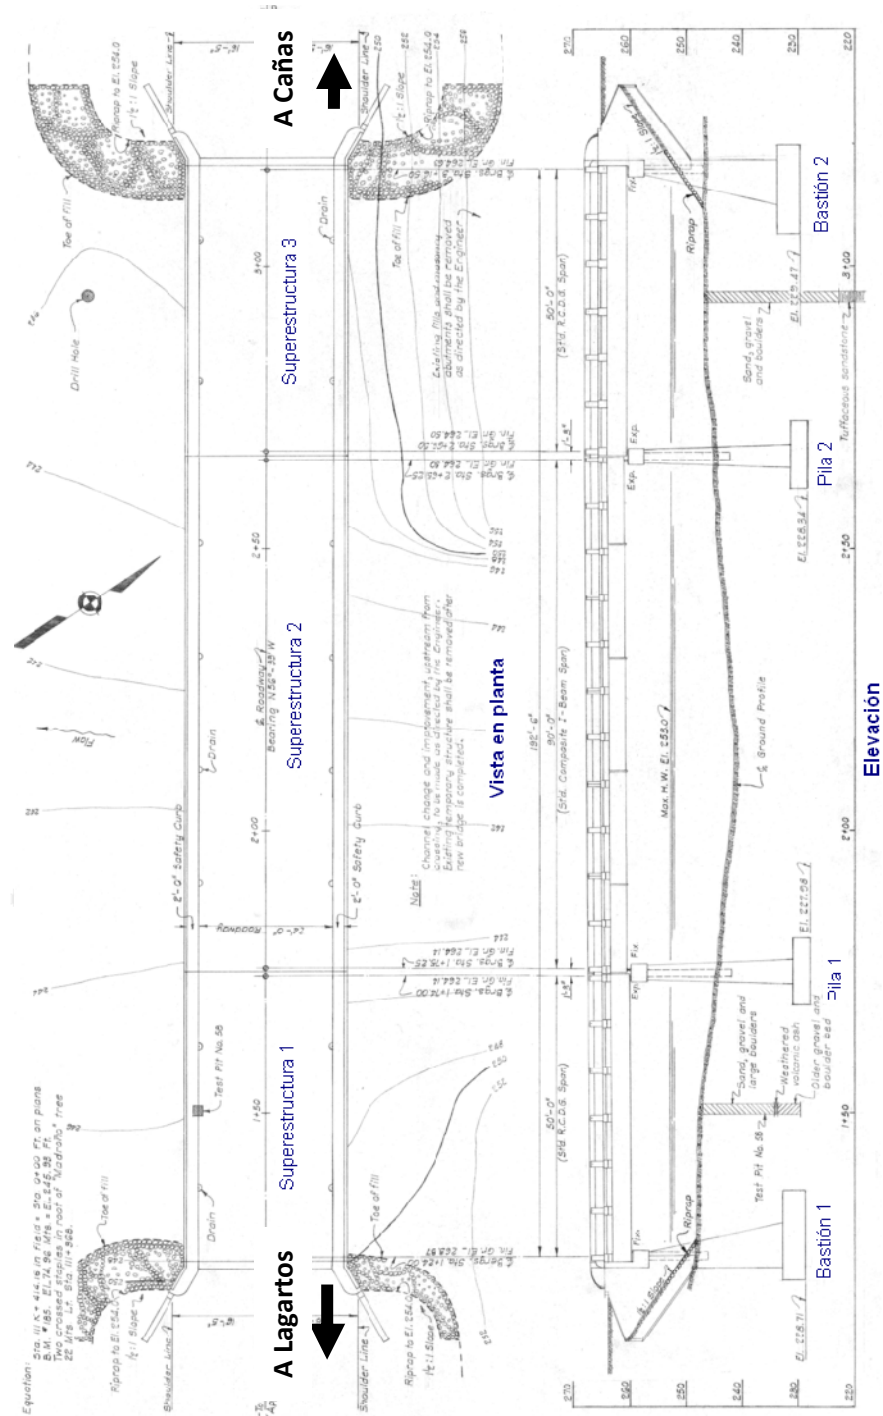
Vista en planta y en elevación en planos estructurales y nomenclatura utilizada para la identificación de los distintos componentes del puente sobre el río Cañas.
